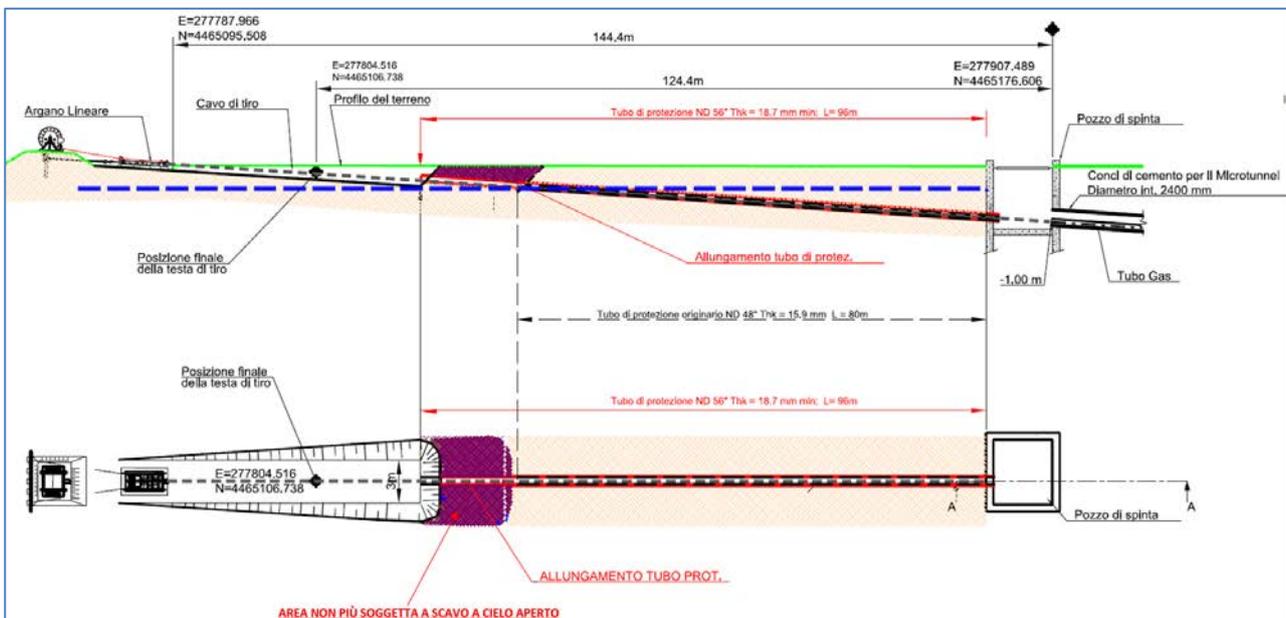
Profilo longitudinale di installazione del tubo di protezione - le linee in rosso identificano il profilo ottimizzato
